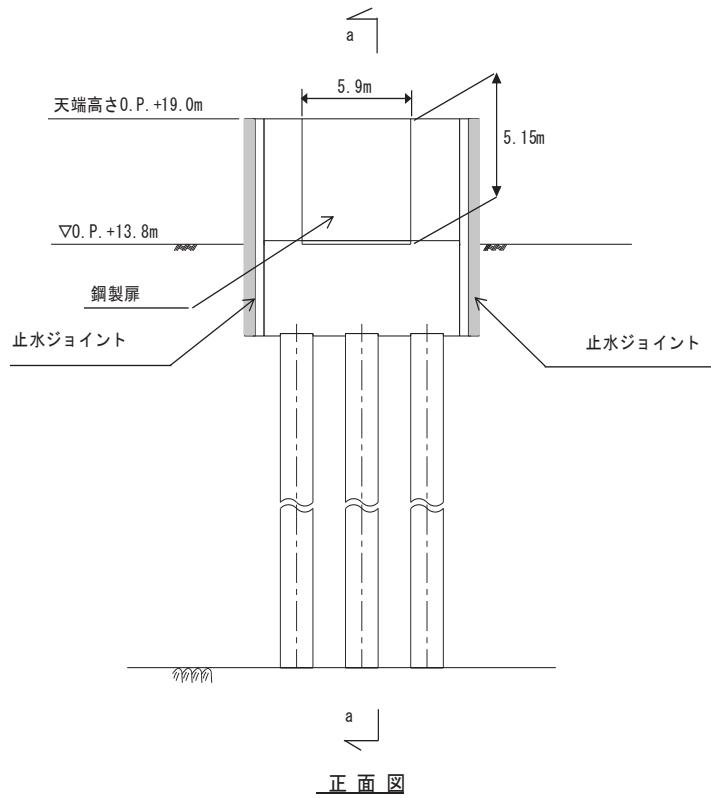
鋼製扉 1 正面図及び断面図
